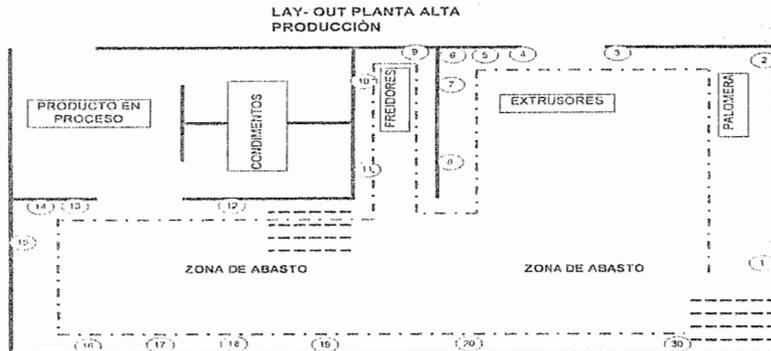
Lay-out cinturón de trampas mecánicas parte alta de la planta.
